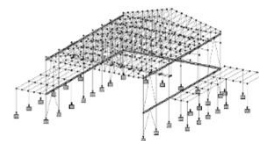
Vigas de Arriostres V3 W8x18 para las Vigas del Teatro
